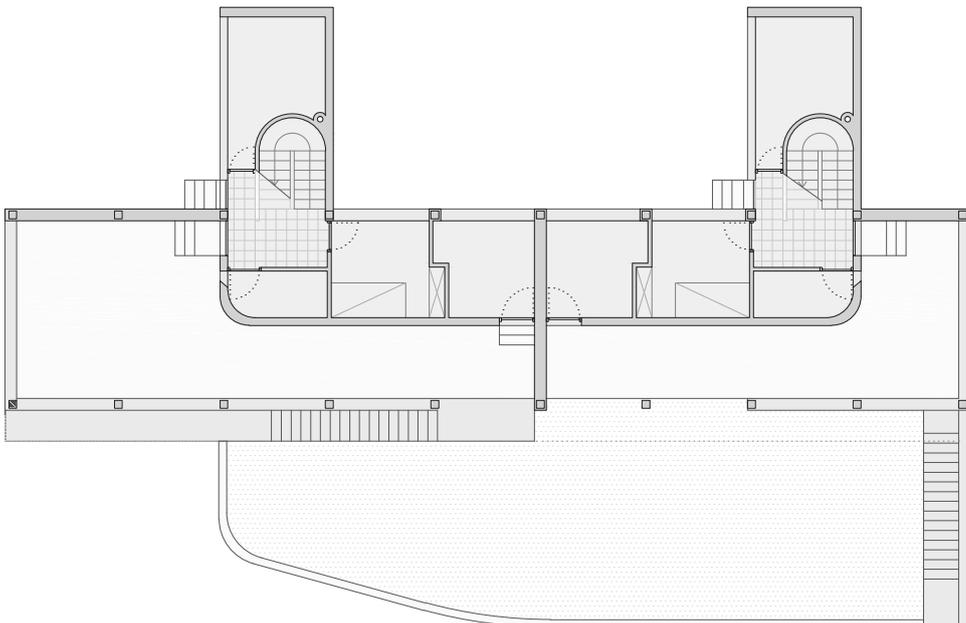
Planta de cubierta del bloque C2 de la Weissenhofsiedlung.
